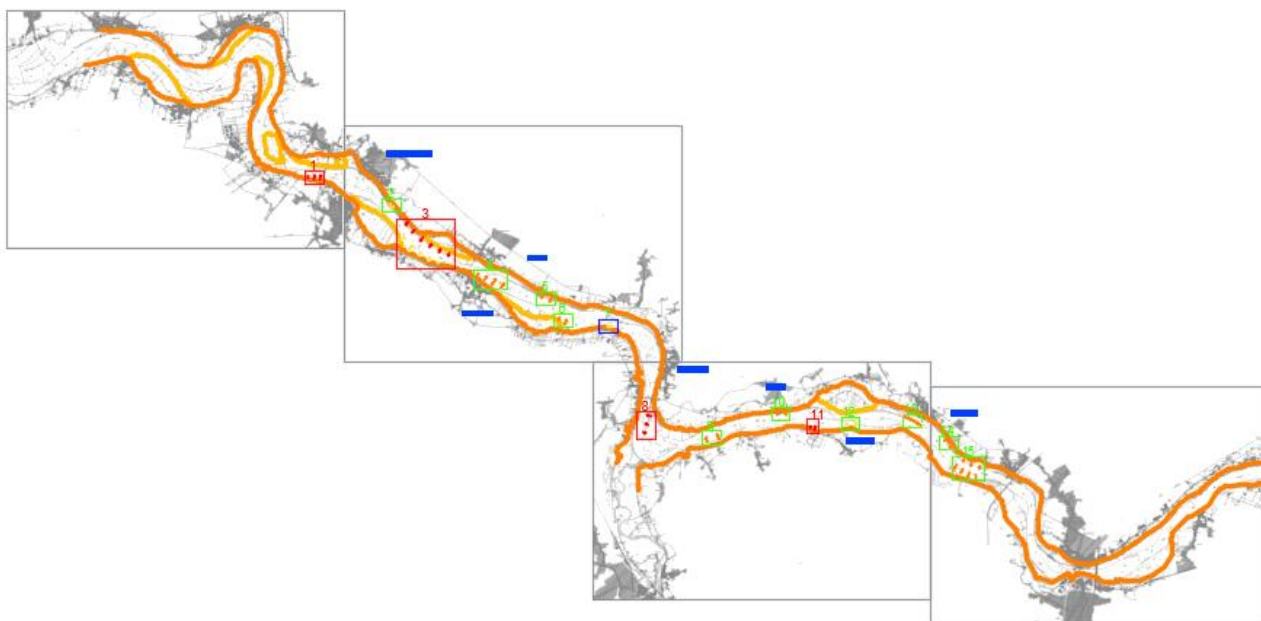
Planimetria interventi stralcio oggetto di Finanziamento
